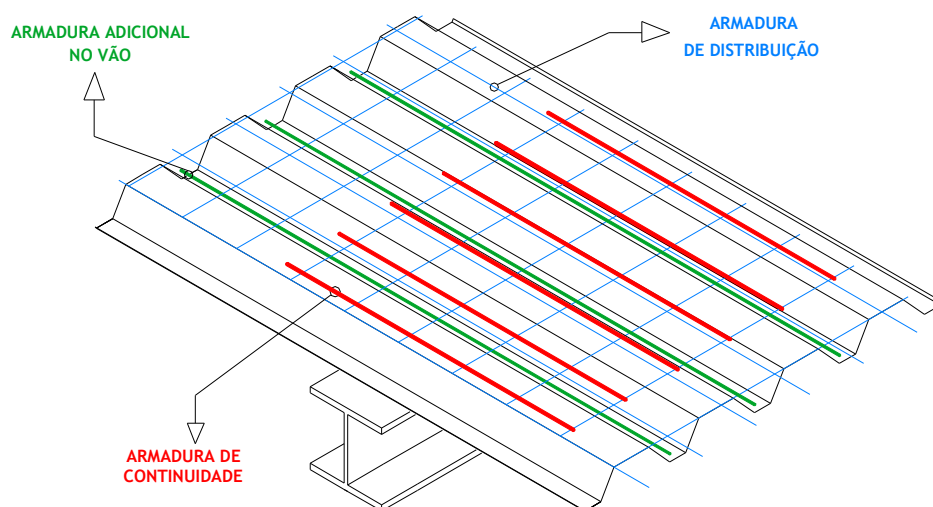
Disposição esquemática das armaduras em lajes mistas.
